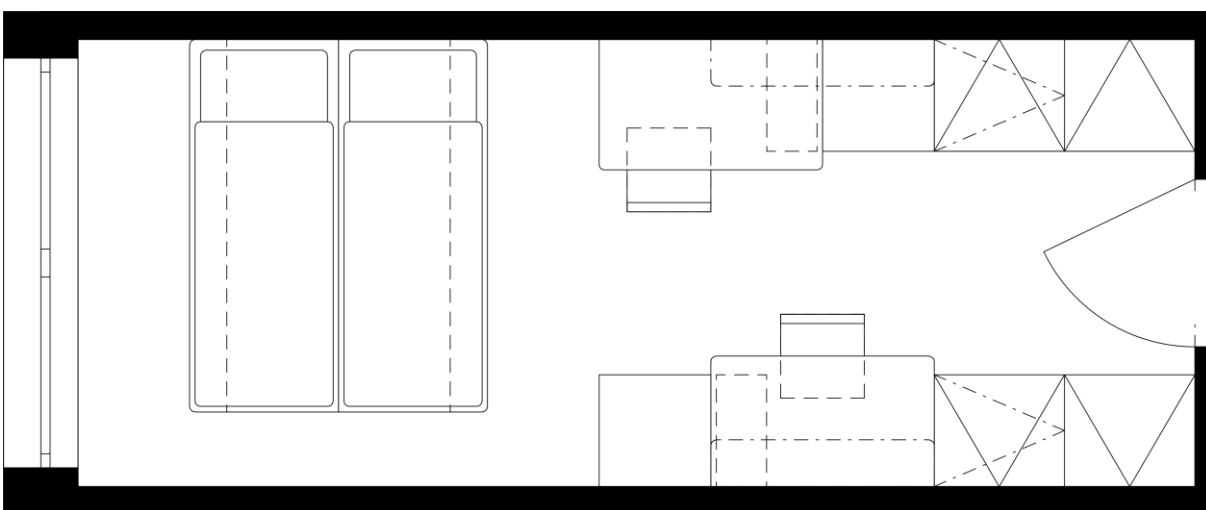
Půdorys dispozice pokoje zigzag kolejí Strahov, 2023
